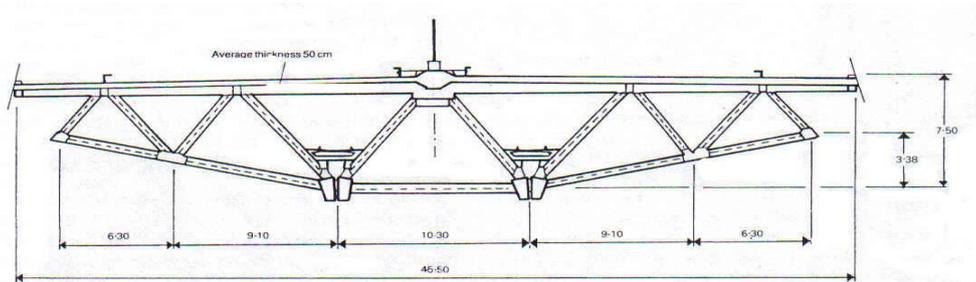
Esquema del tablero del puente Ivory Coast
